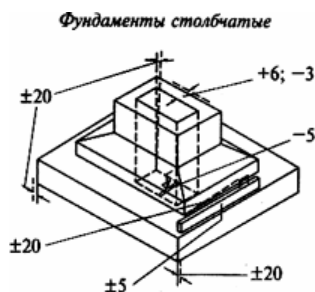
Технологические схемы допустимых отклонений, мм столбчатых фундаментов
